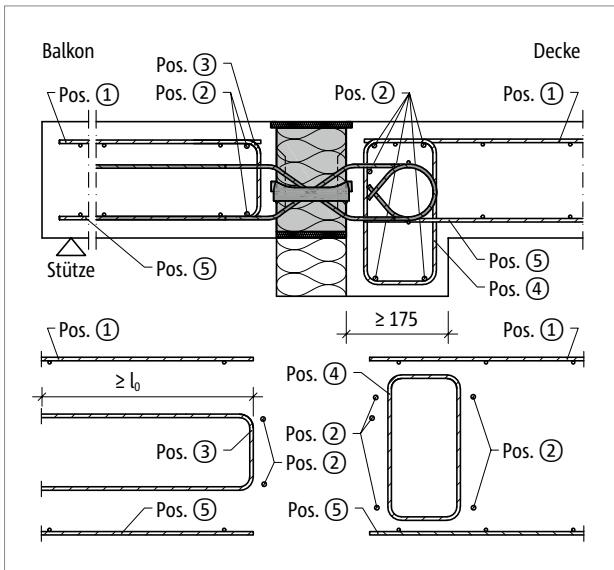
Schöck Isokorb® XT Typ QL-VV1 bis VV4 Bauseitige Bewehrung in Unterzug
